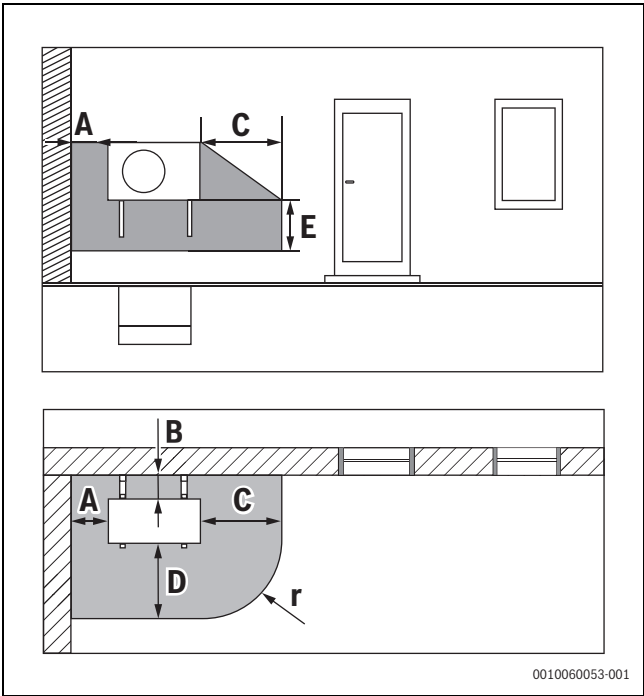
Schutzbereich, wandmontierte Wärmepumpe
